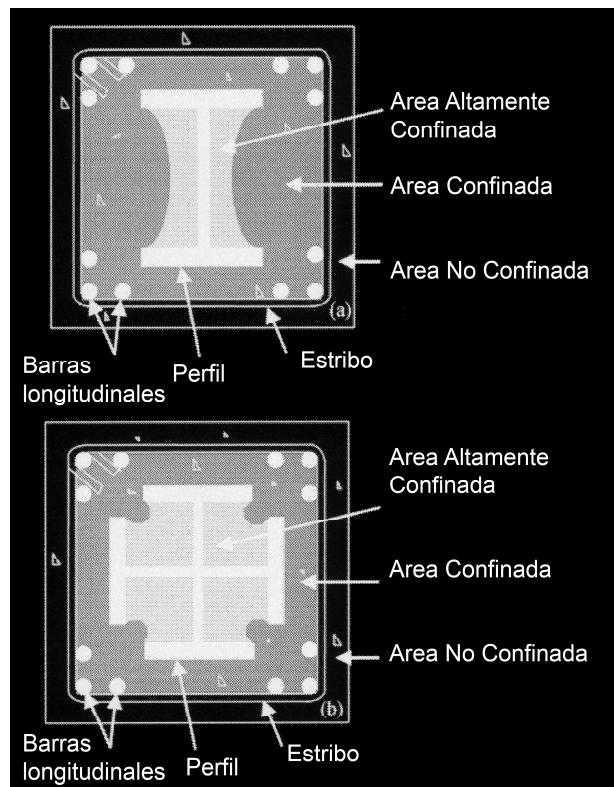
Tipo de condiciones de confinamiento del hormigón para columnas SRC [35]
